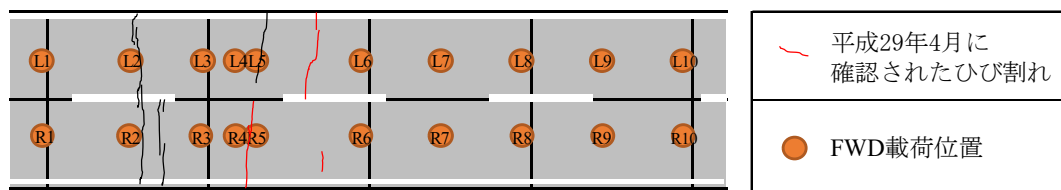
凍上量測定箇所における新たなひび割れ位置
